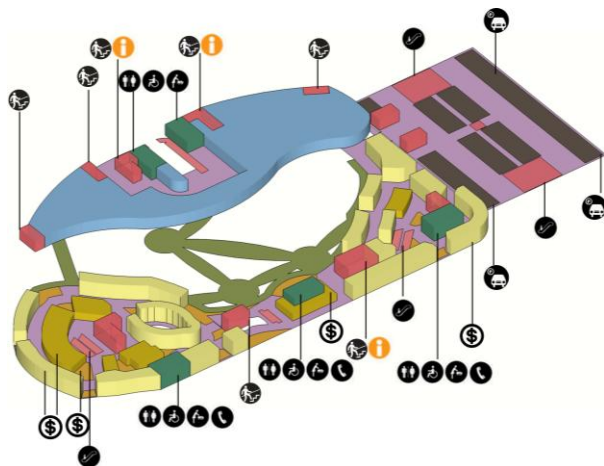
Denah *Layoutplan*. Sumber: penulis.
